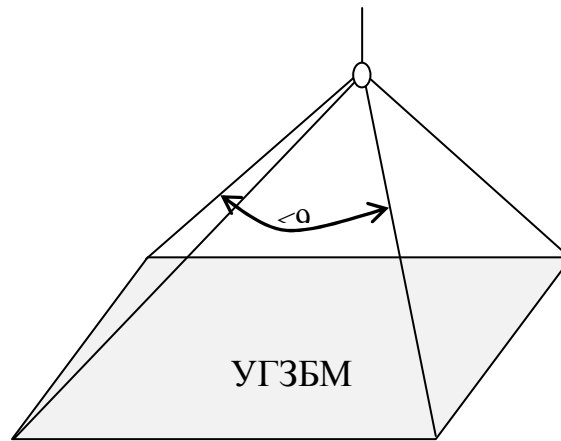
Схема строповки УГЗБМ при погрузке, разгрузке и укладке.
